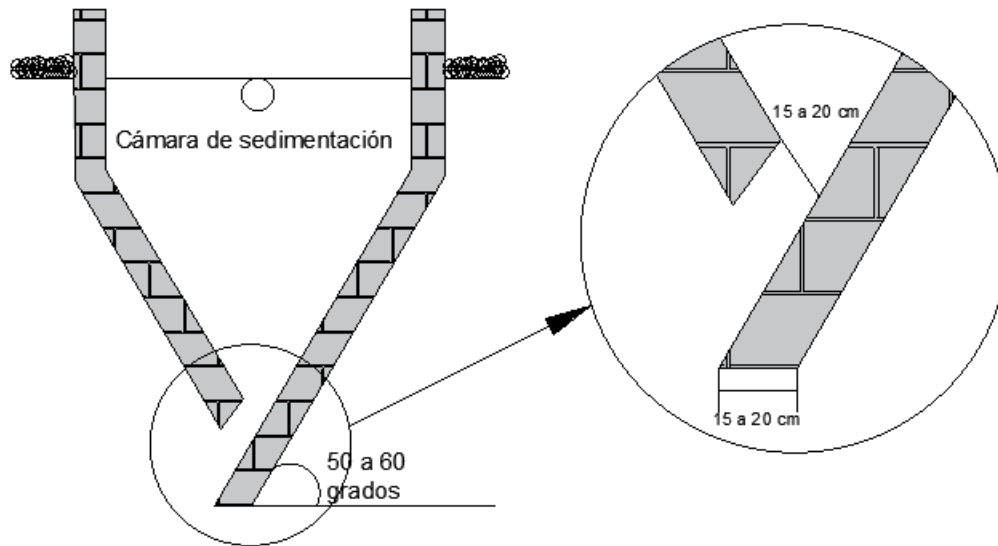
Separación de arista central de la cámara de sedimentación.
